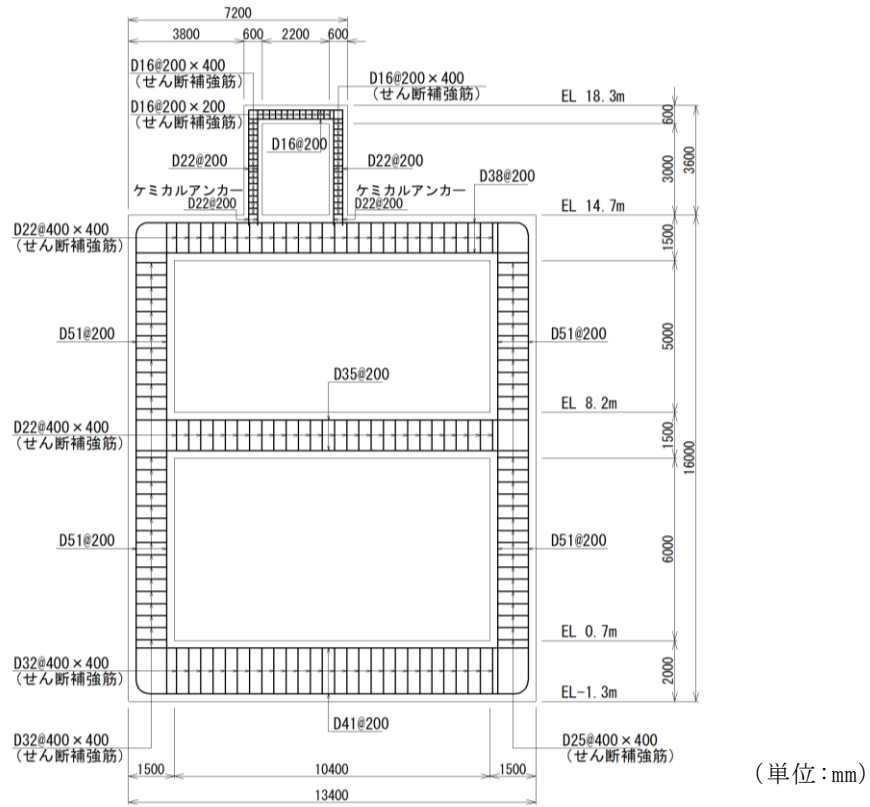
低圧原子炉代替注水ポンプ格納槽 概略配筋図 (A-A 断面)
